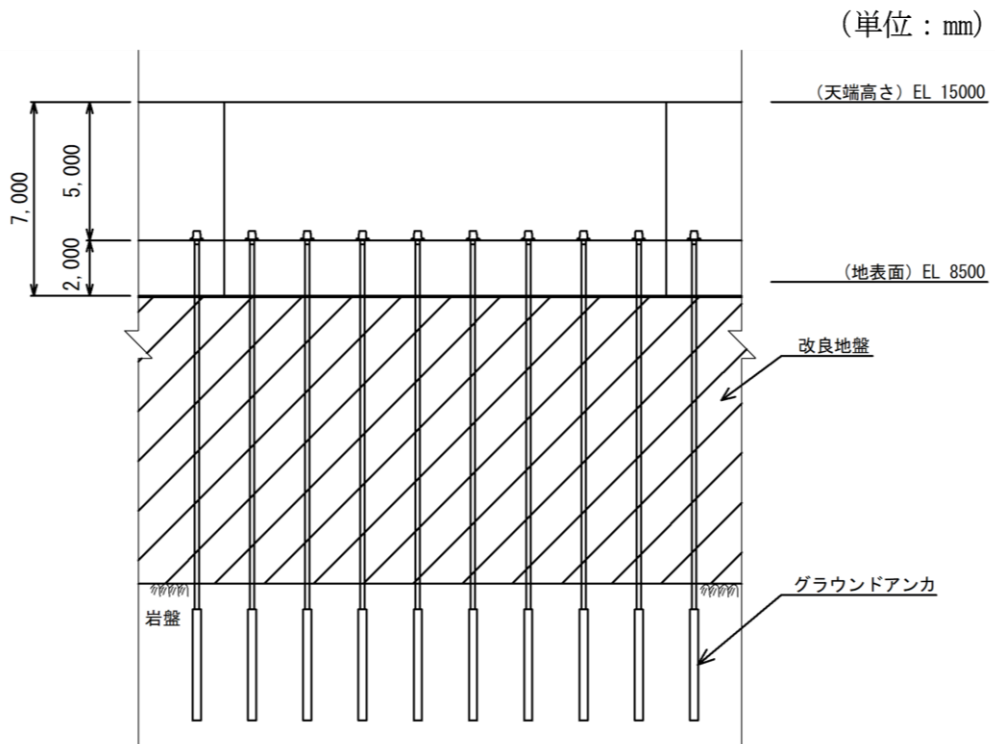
(1) 防波壁（逆 T 擁壁）の構造図（正面図）
